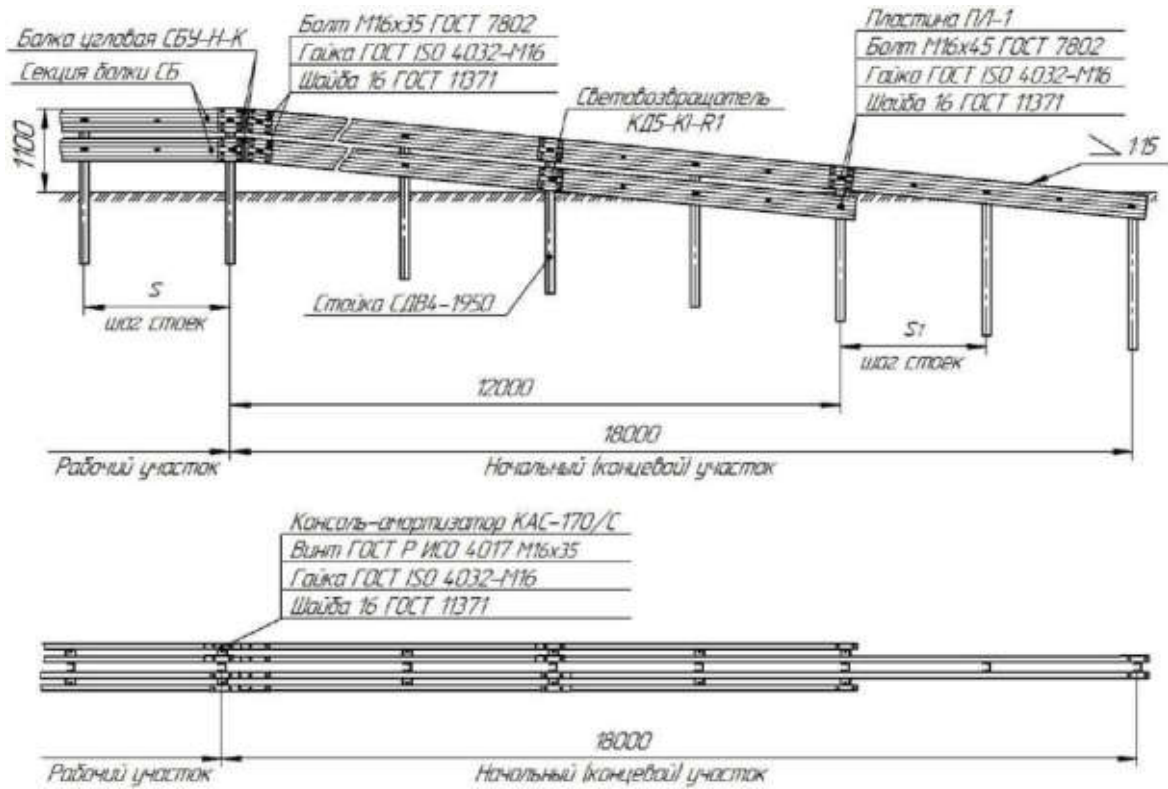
Схема сборки конструкции №18 (Изм. №1)
